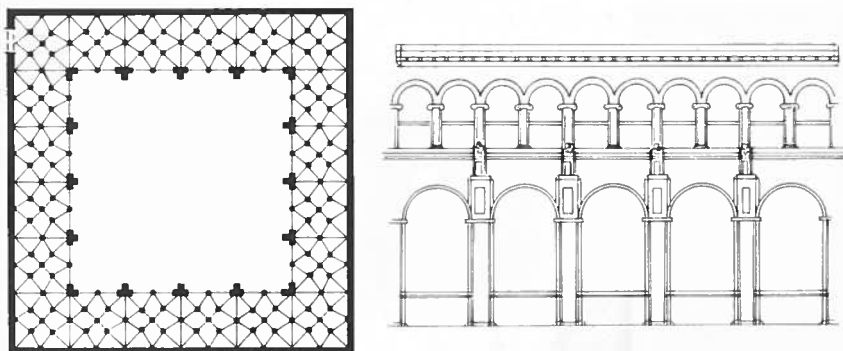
Planta y alzado del claustro del monasterio de San Pedro de Eslonza (León).
